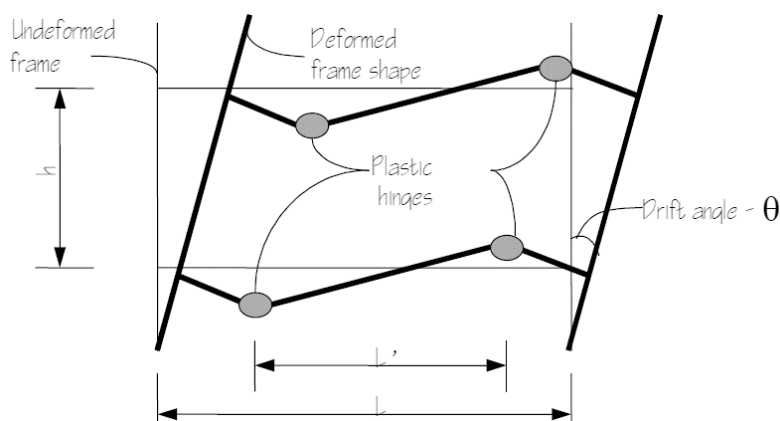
Comportamiento Inelástico de Pórticos con Rótulas Plásticas en Vigas
